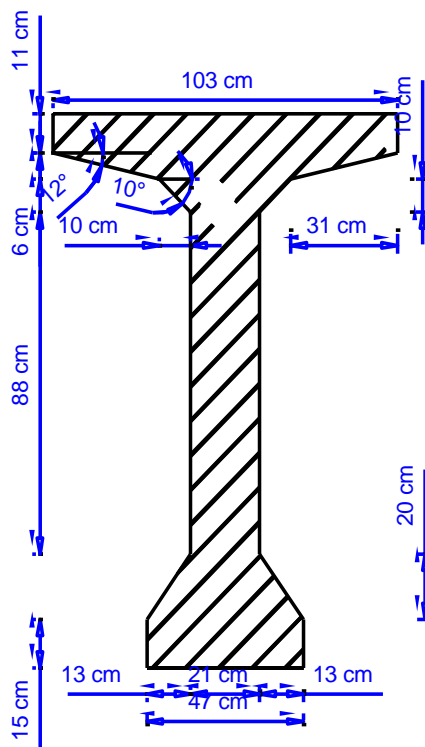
Coupe transversale de la poutre à mi-travée
